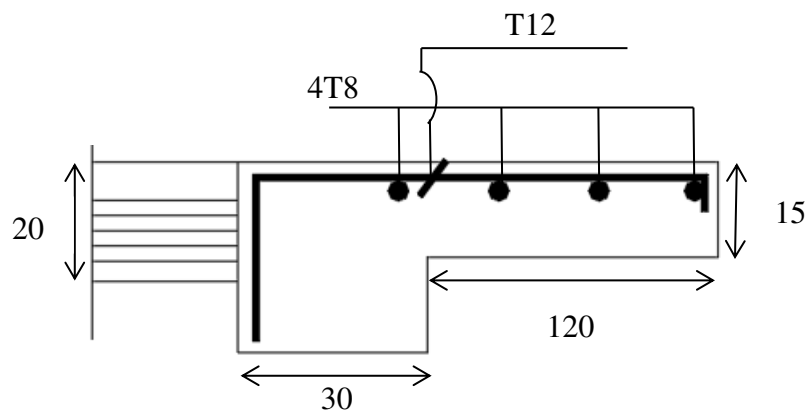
Schéma de ferrailage de balcon.
